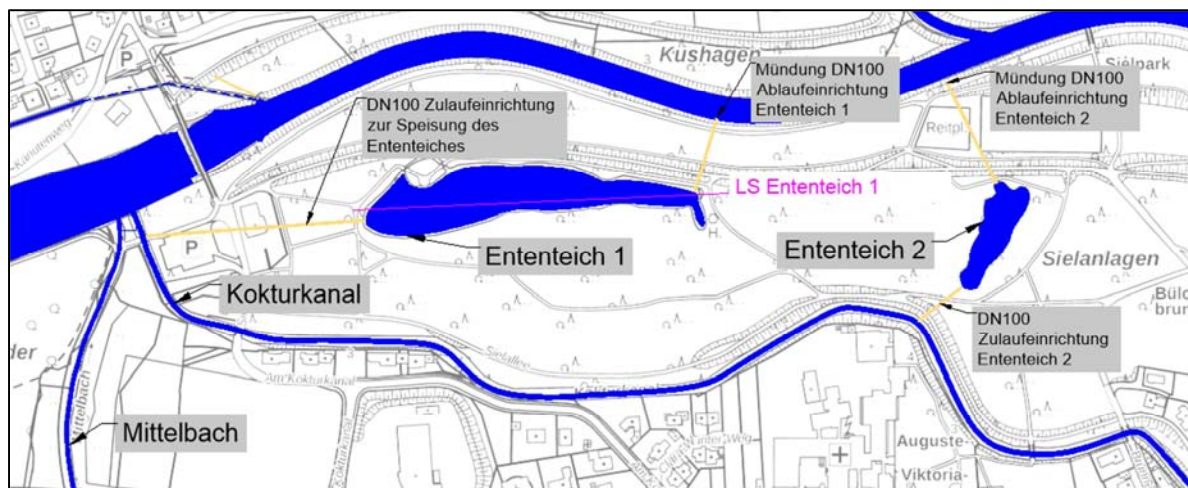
Lageplan Bestand - Teichanlagen 1 + 2, mit zu und Ablaufsystemen
